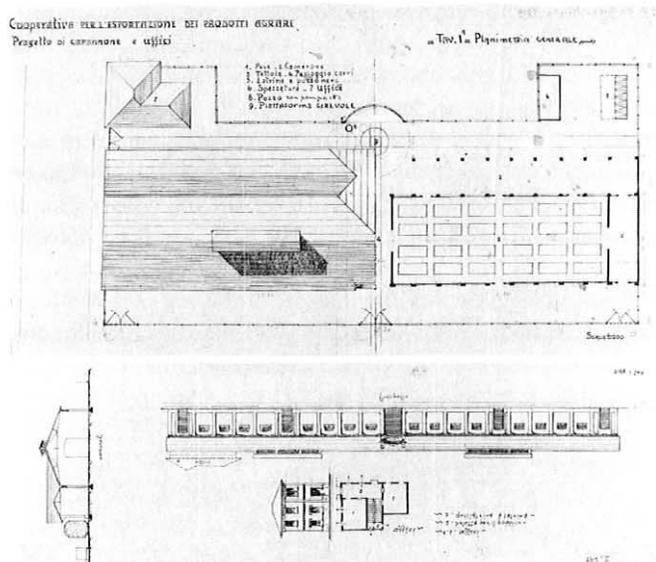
Progetto per la costruzione di edifici per la lavorazione della frutta nei pressi della stazione ferroviaria - Pianta e prospetti.
